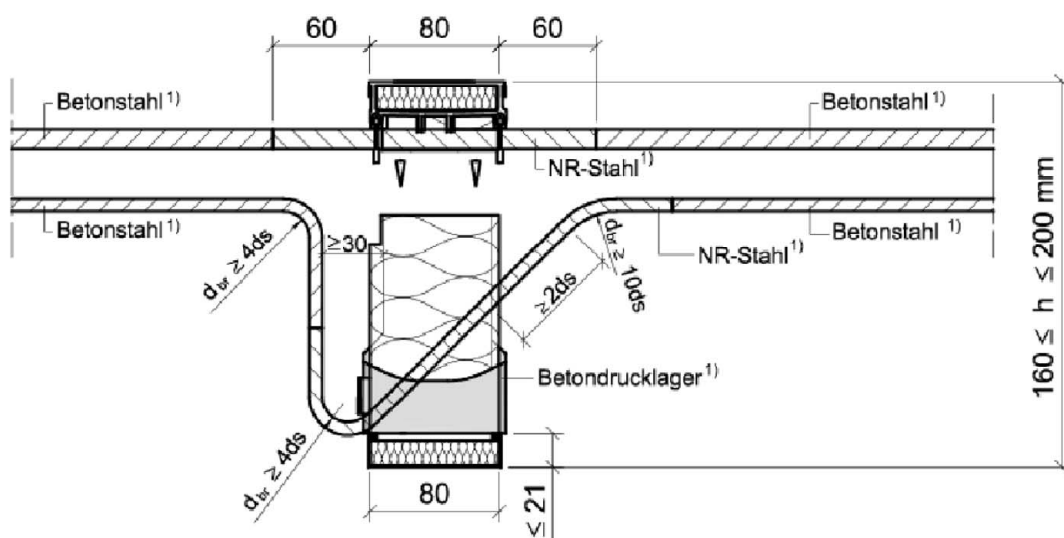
Beispiel Schöck Isokorb® T Typ K-ID mit Betondrucklager mit integrierter Aufhängebewehrung
